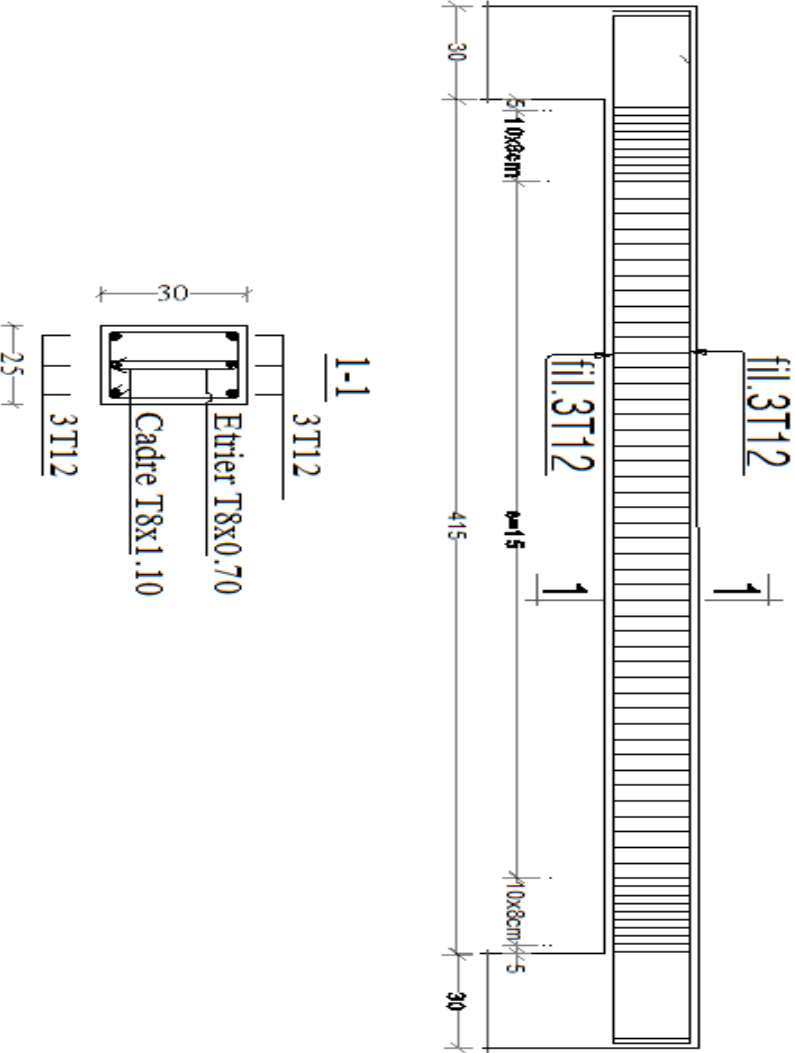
5: Plan de ferrailage de poutre de chaînage
